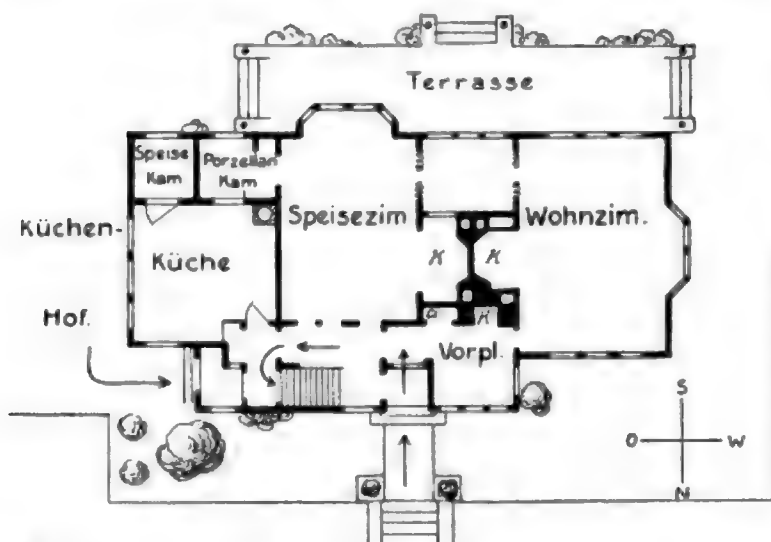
GRUNDRISS DES AMERIKANISCHEN LANDHAUSENTWURFS; Untergeschoß.
